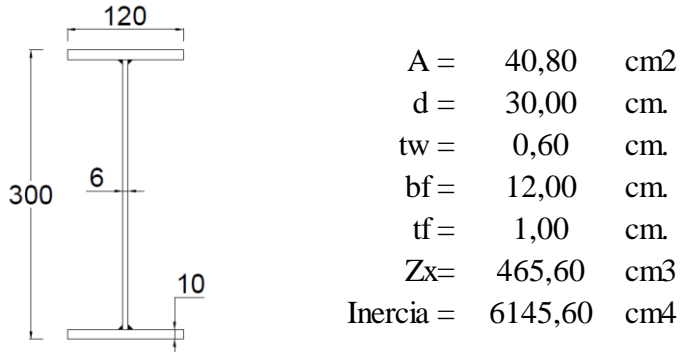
2 Sección 1 acero soldado viga secundaria
